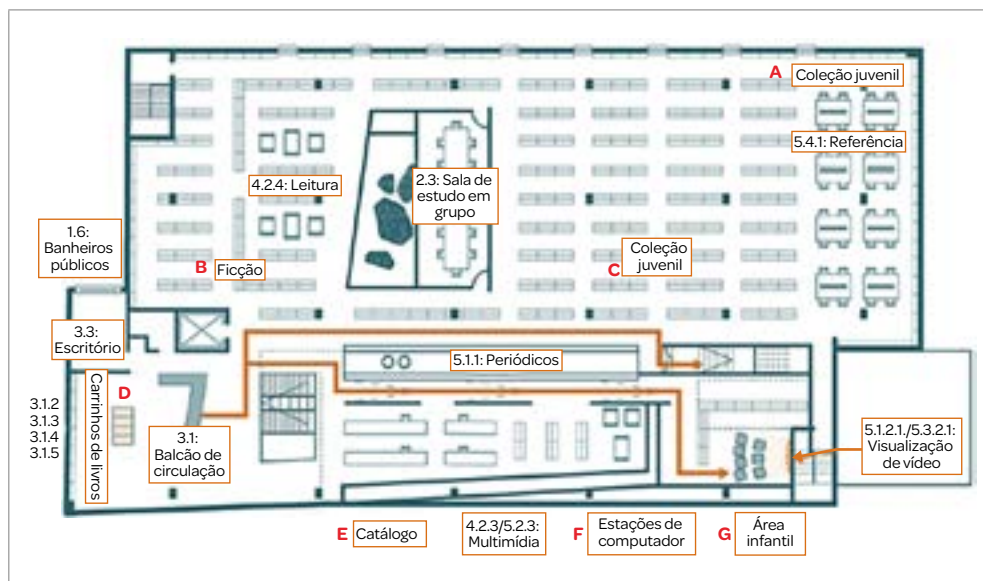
Planta do 1º andar da futura biblioteca com anotações do ergonomista.
